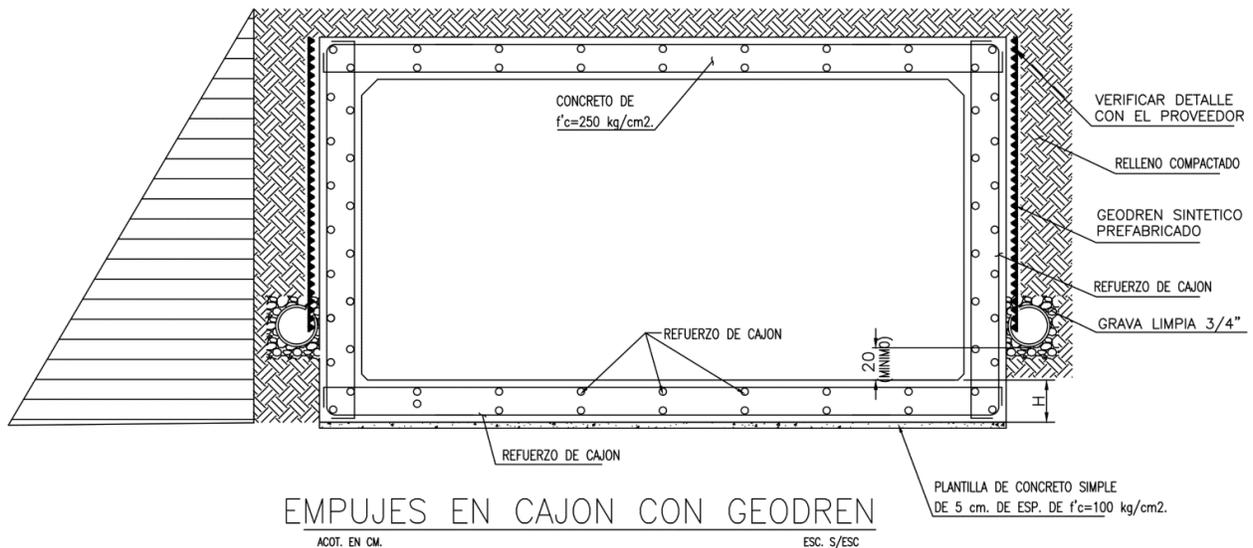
Empuje generado únicamente por la acción del suelo sobre el muro de la obra de drenaje, debido a un adecuado sistema de drenaje perimetral.
